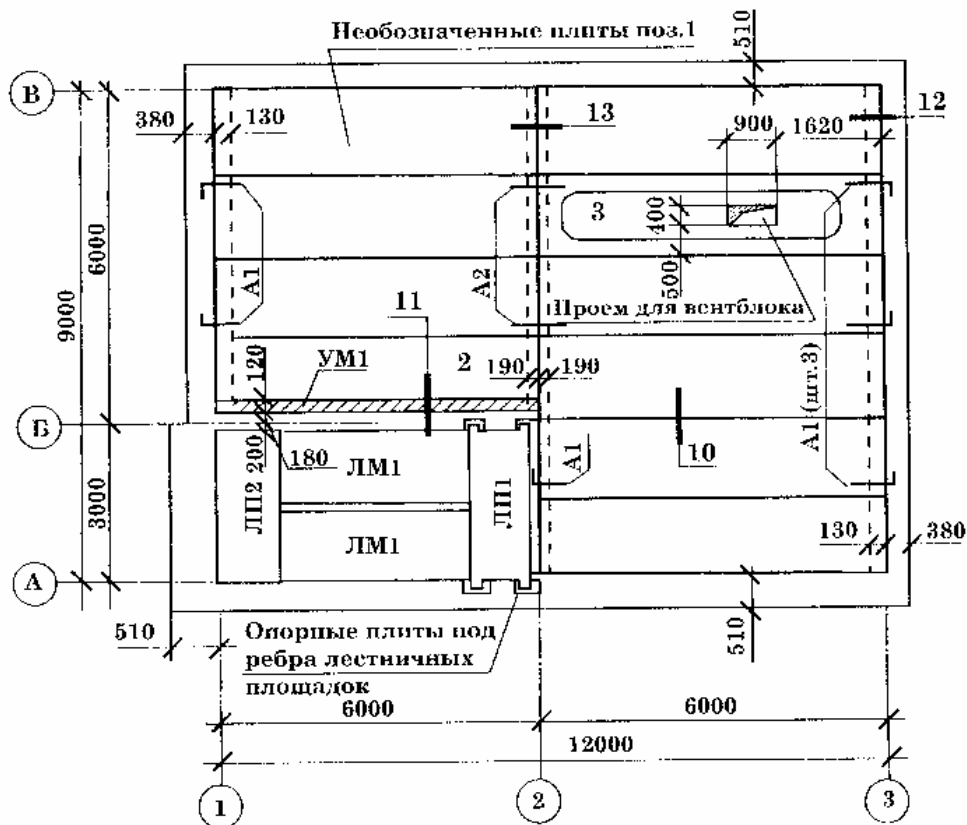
Пример оформления плана перекрытий на отм.  $\pm 3.000$
